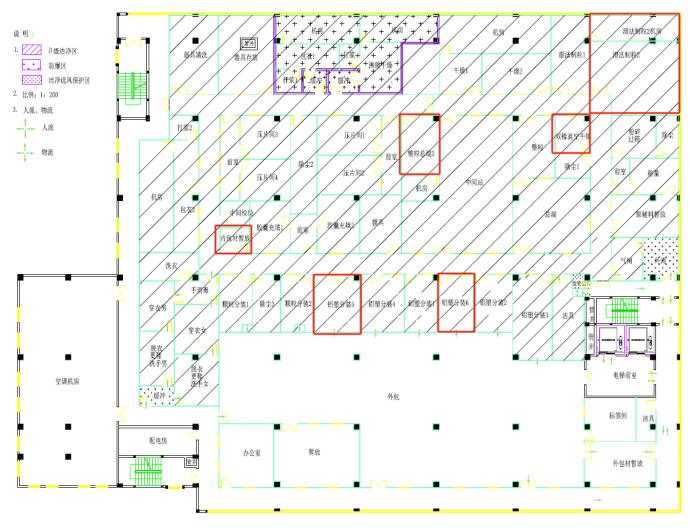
本项目变动后综合制剂生产车间二层平面布置图
